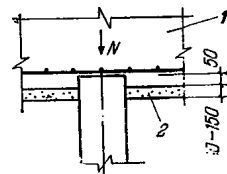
Пример конструктивного решения сопряжения железобетонных свай, работающих на нормальные сжимающие усилия, не выходящие за пределы ядра сечения свай, с монолитными (кустовыми и ленточными) ростверками при погружении свай до проектной отметки
